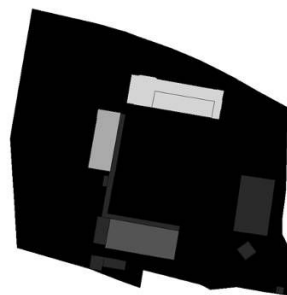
Esquema da planta de implantação da Escola Secundária Francisco de Arruda, em Lisboa.
